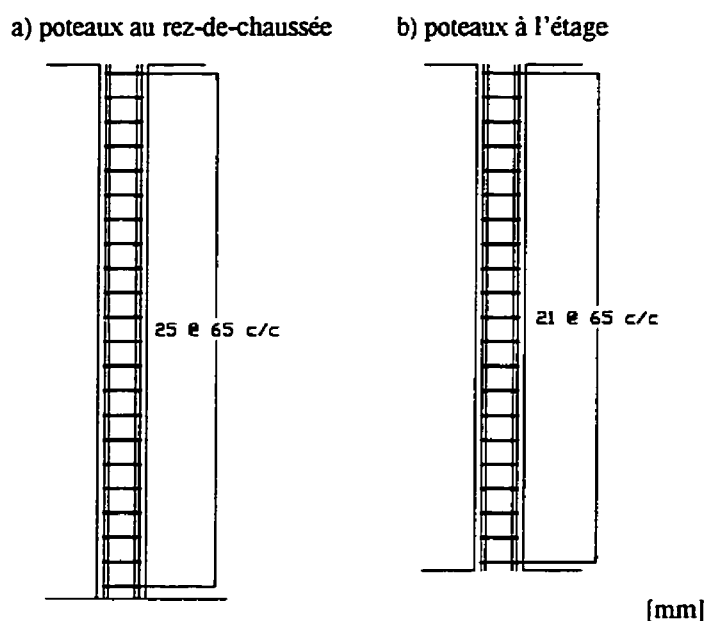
Disposition de l'armature transversale dans les poteaux.
